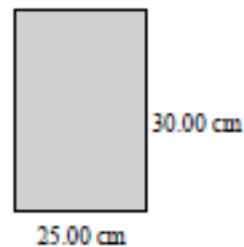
SECCIÓN DE LA VIGA LONGITUDINAL
